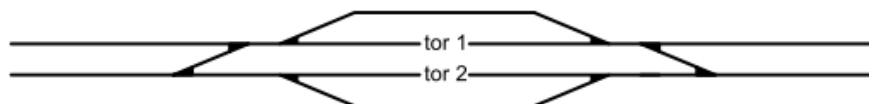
Połączenia torów w układzie dwutrapezowym
